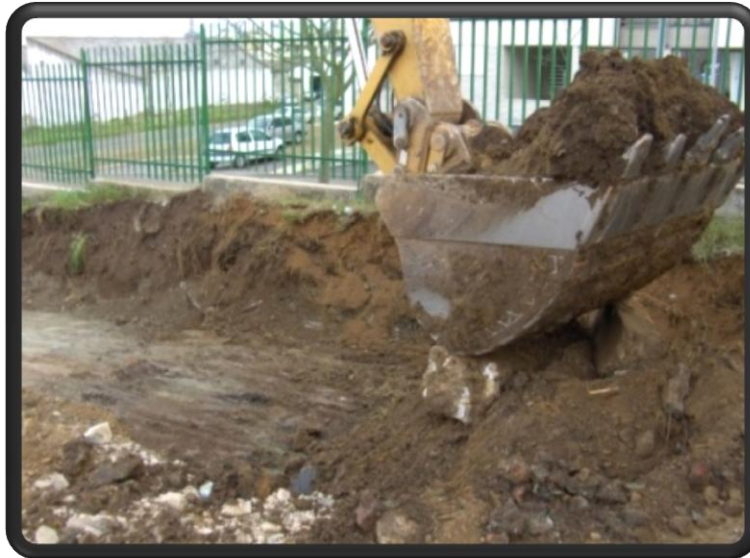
Escavação na zona Sul da obra para a fundação do muro de suporte
